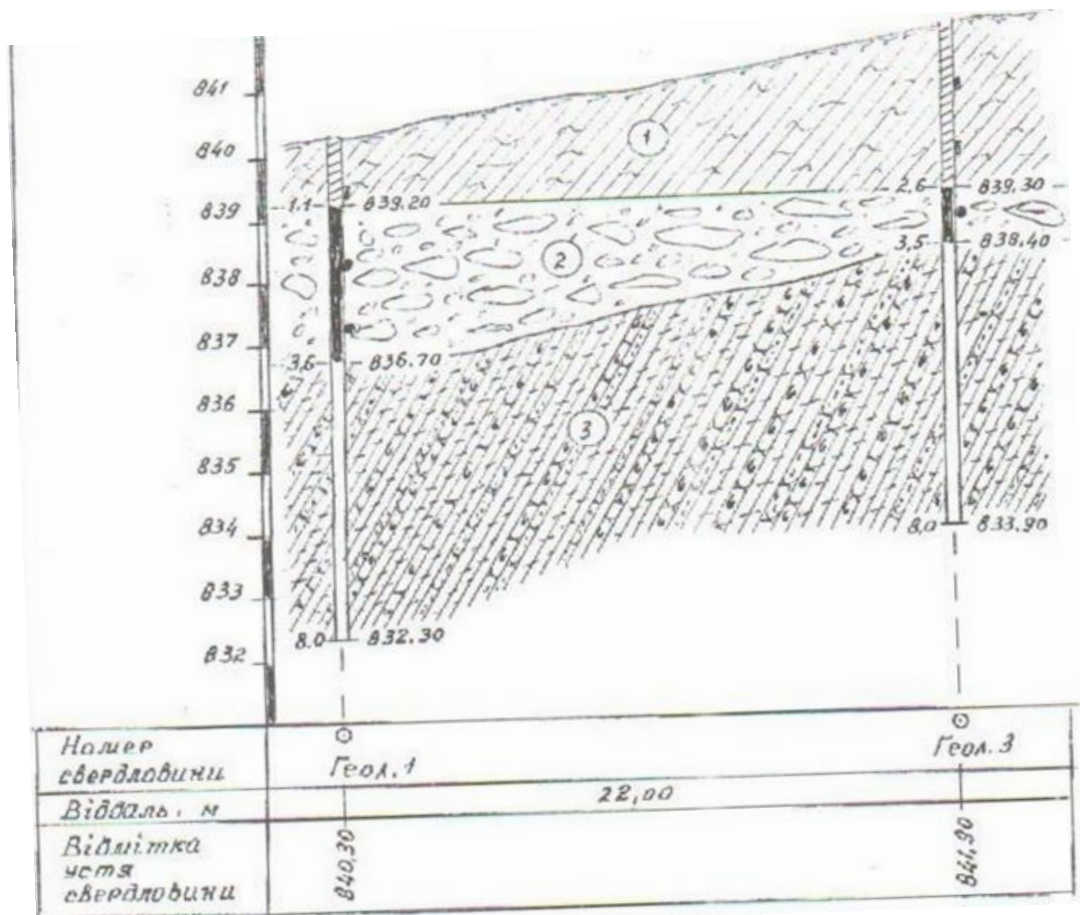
Геологічний розріз ділянки по свердловинах 1-3
